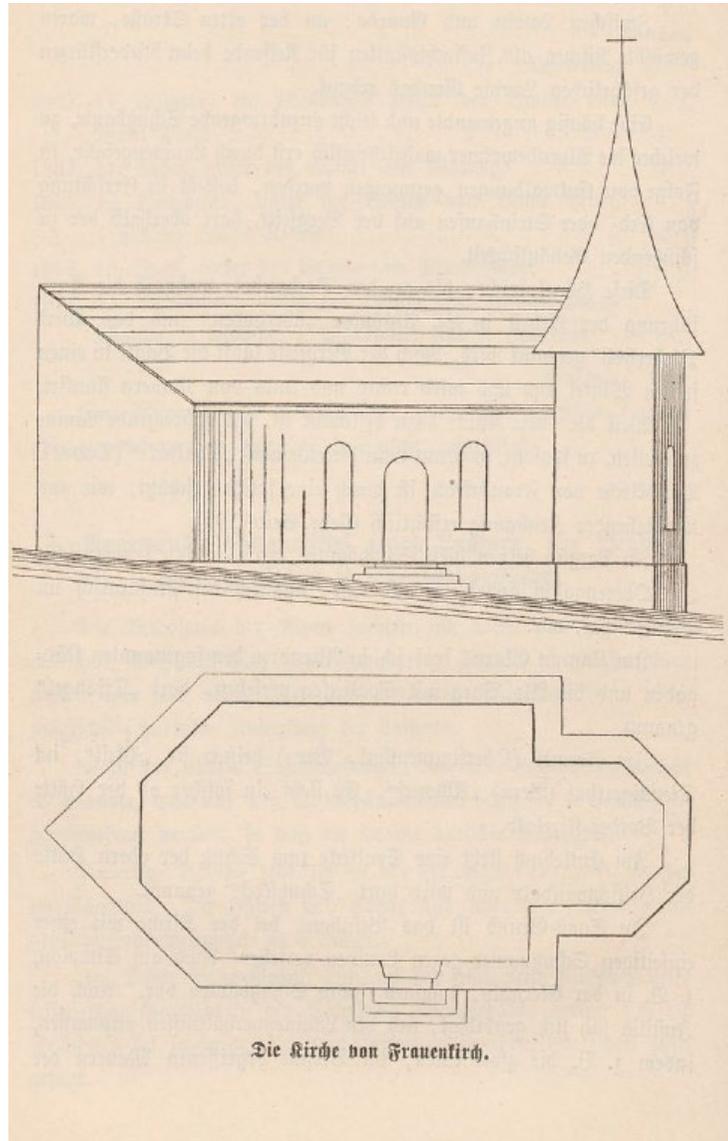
Detailplan des Spaltkeils von Davos-Frauenkirch um 1881.
